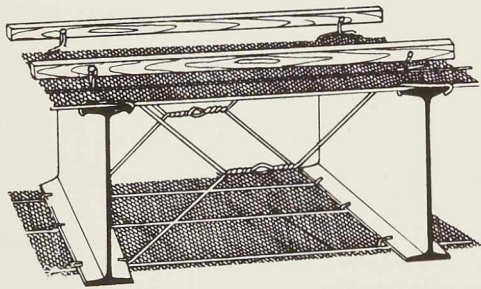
Plancher avec dalles coulées sur métal déployé.
